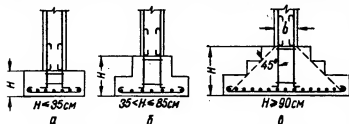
131. Ступенчатые железобетонные фундаменты:
